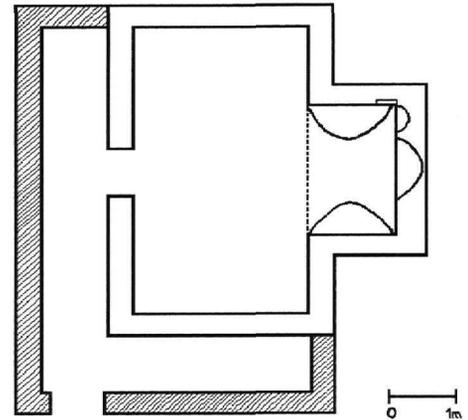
Cerskë, Marienkirche. Grundriss.
